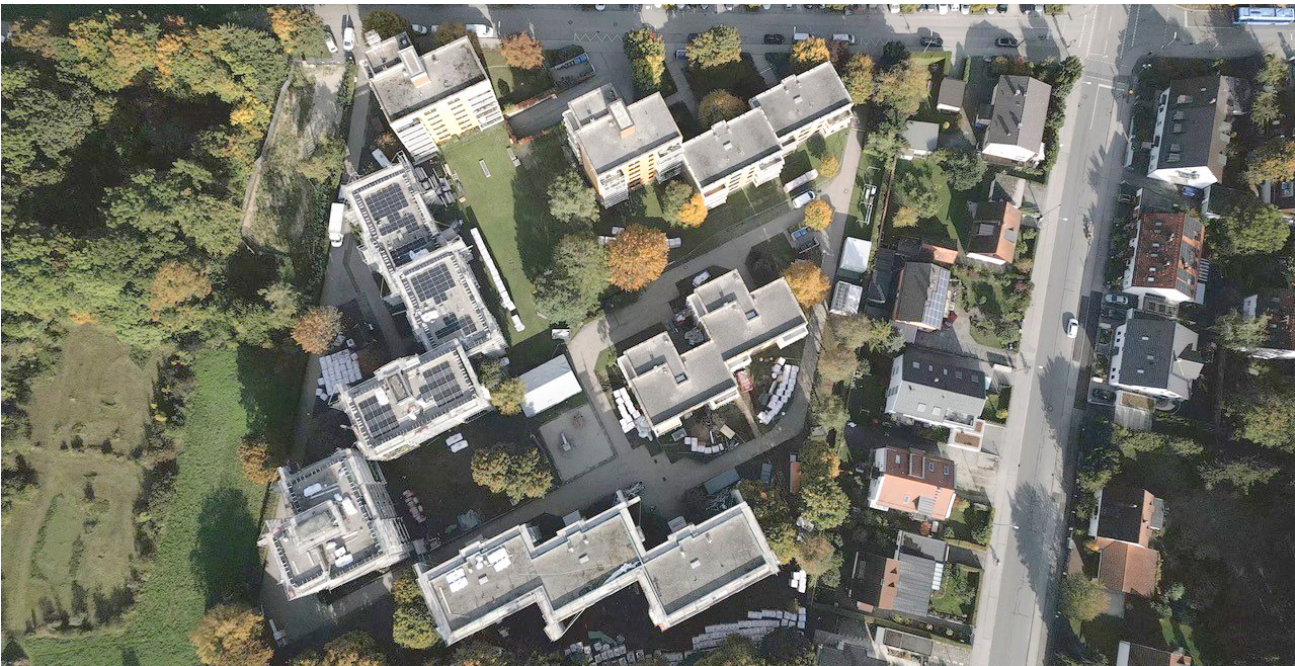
Dachaufsicht Zwischenstand der Sanierung, teilweise bereits mit Photovoltaik
